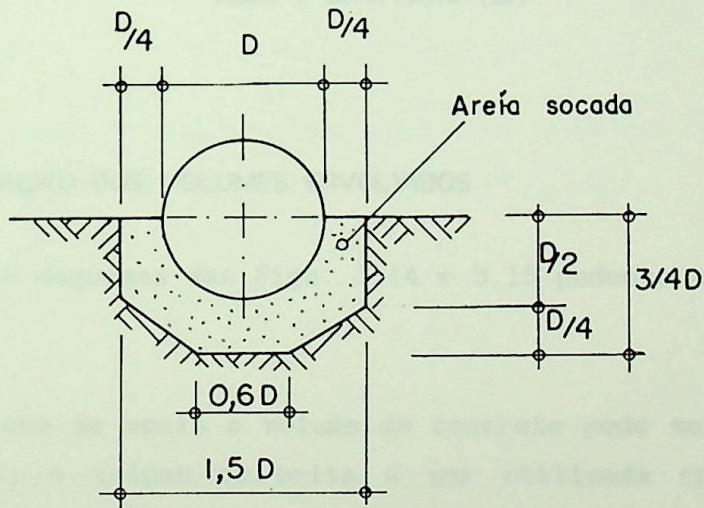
Assentamento da Tubulação de Baixa Pressão de Concreto ou de Cimento Amianto
